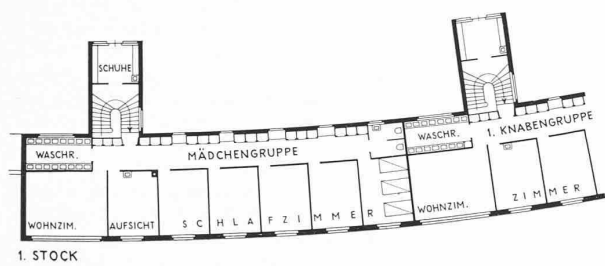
Zöglingflügel, Teilgrundrisse und Schnitte
